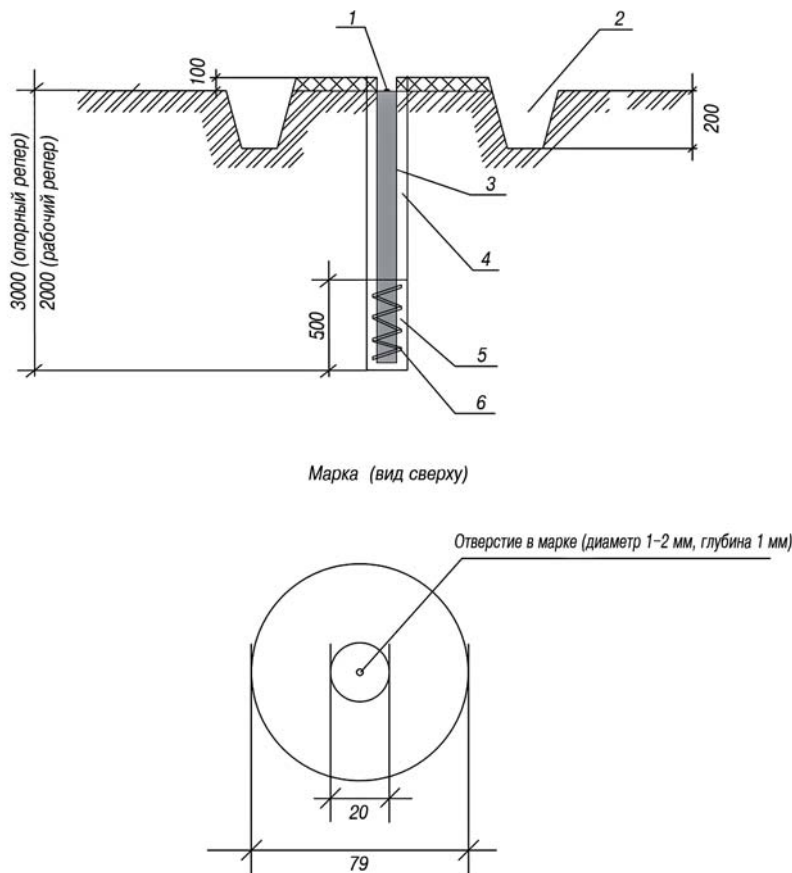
Закладка и устройство опорного и рабочих реперов: 1 — марка (место передачи координат и высоты); 2 — окопка вокруг репера; 3 — металлическая труба диаметром 79 мм; 4 — скважина диаметром 300 мм; 5 — заливка якоря бетоном; 6 — якорь из арматуры
